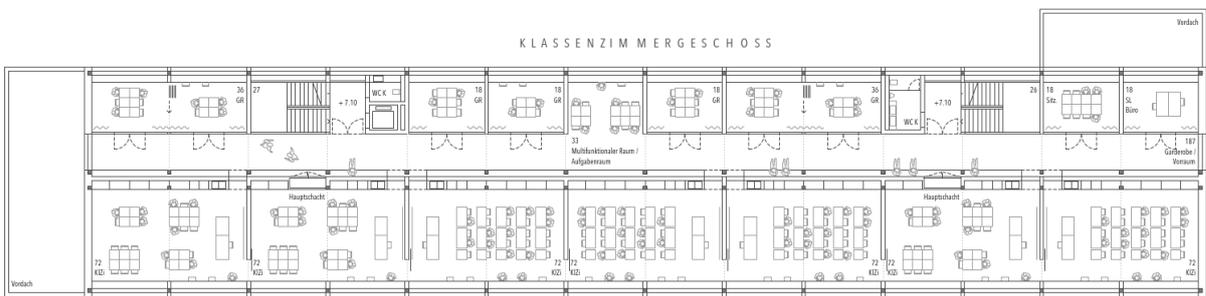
Grundriss Neubau Sekundarschule, 2. Obergeschoss
